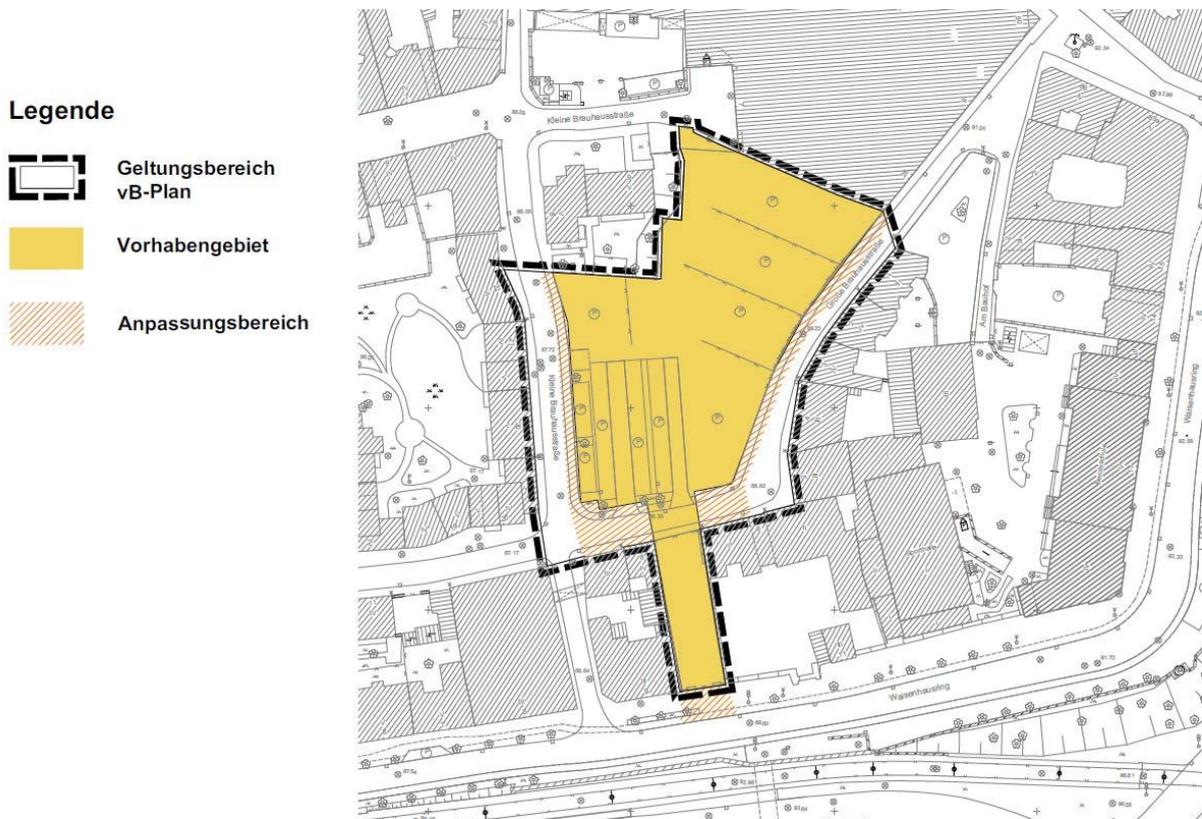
Geltungsbereich, Kartengrundlage: Stadt Halle (Saale), FB Städtebau und Bauordnung, Abt. Stadtvermessung
